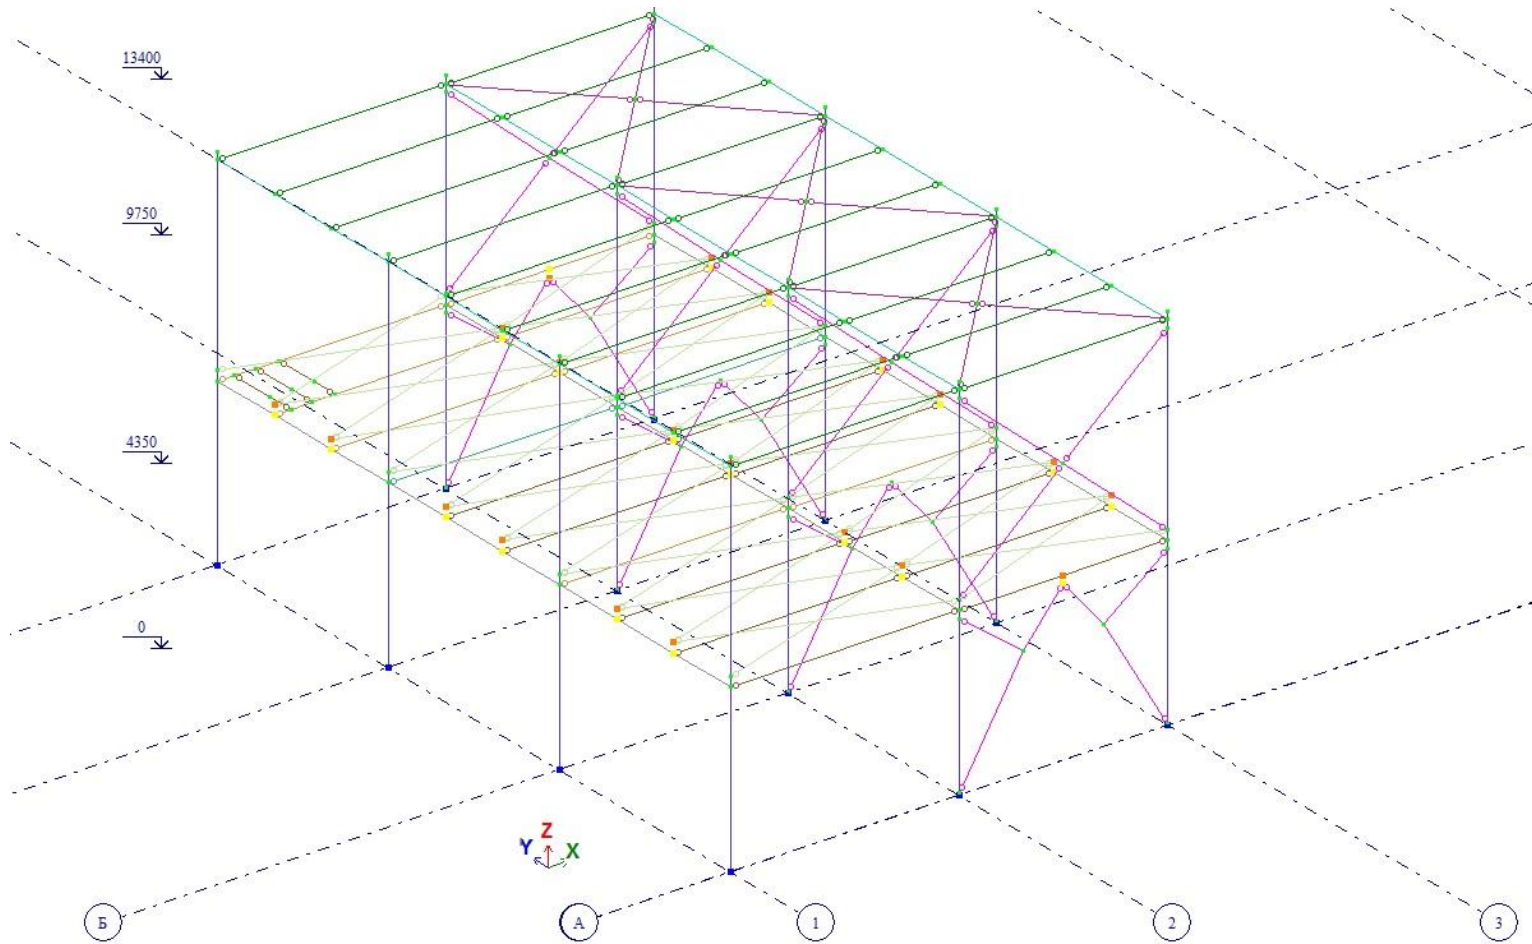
К расчету многоэтажных рам на горизонтальные нагрузки
